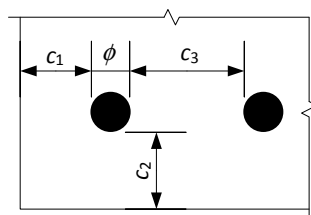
Raio da área de betão efectivo para cada tirante.
